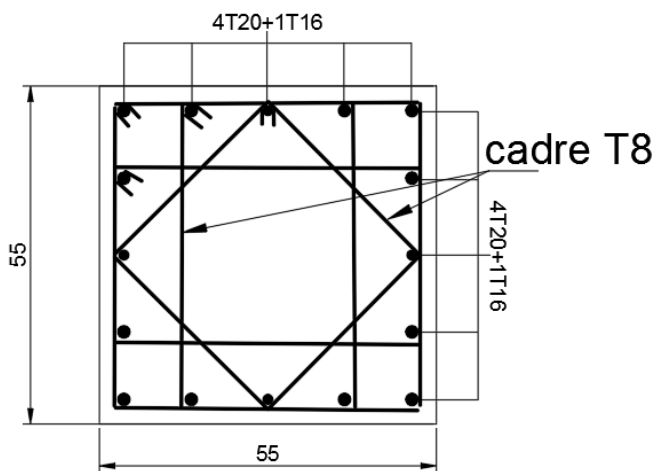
Ferrailage du poteau du 2^{ème} + 3^{ème}
